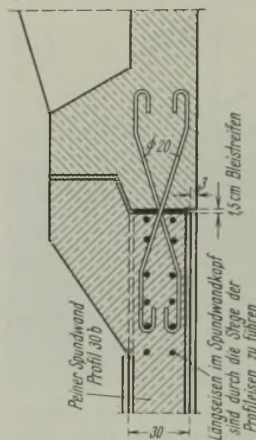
Gelenkiger Anschluß eines Auflagers an die Auflagerwand aus Peiner Spundbohlen bei einer Eisenbetonbalkenbrücke.
